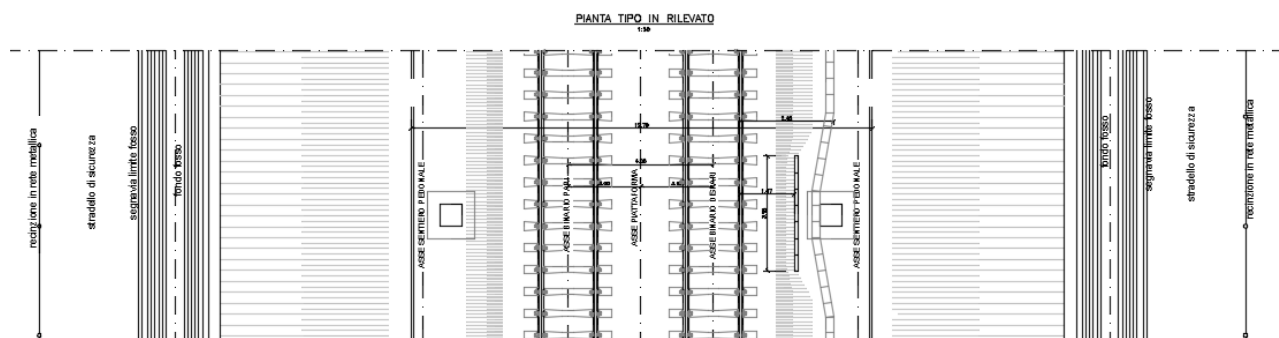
Pianta tipo del rilevato ferroviario di progetto
